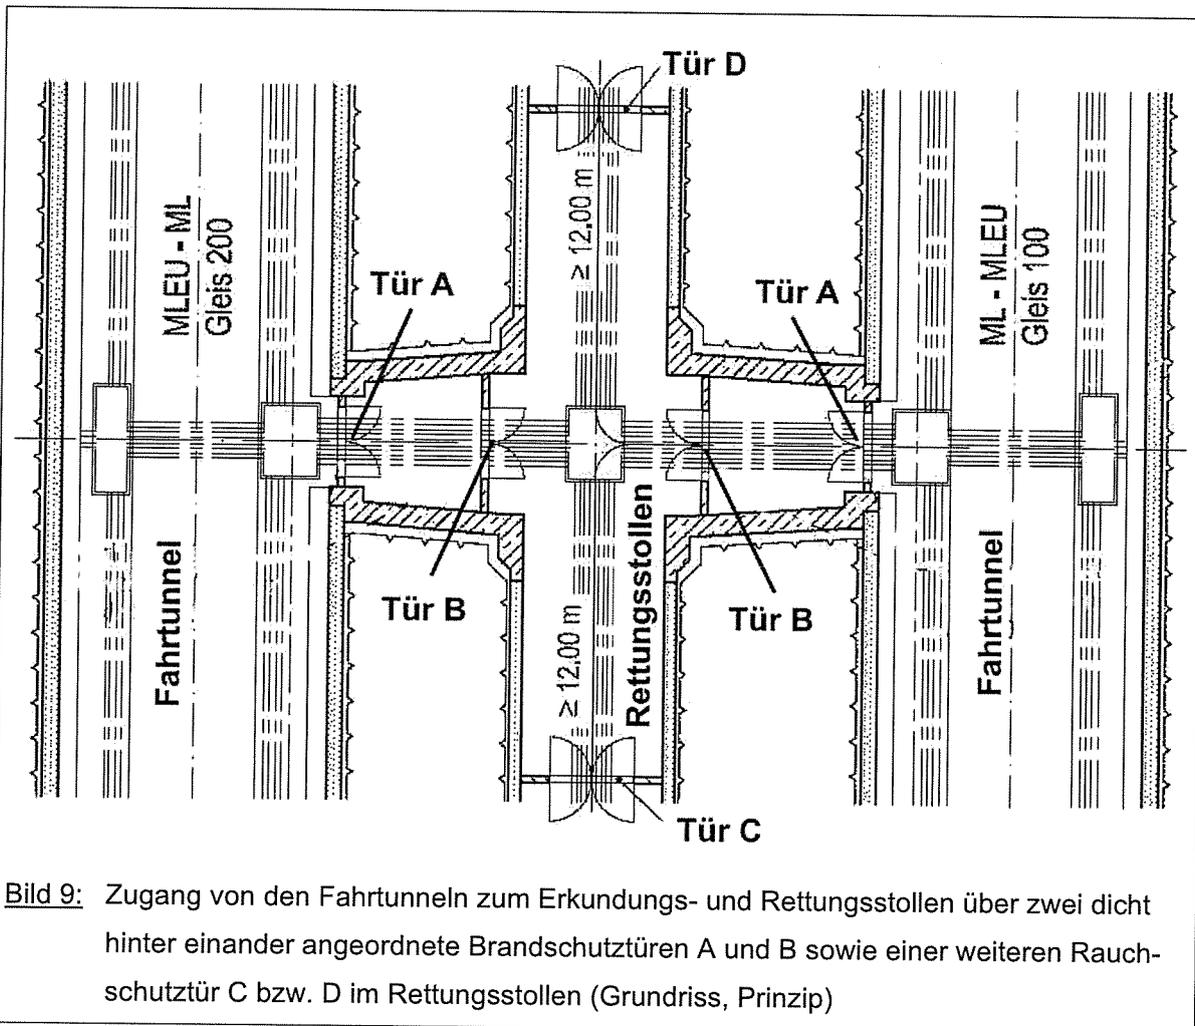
Zugang von den Fahrtunneln zum Erkundungs- und Rettungsstollen über zwei dicht hinter einander angeordnete Brandschutztüren A und B sowie einer weiteren Rauchschutztür C bzw. D im Rettungsstollen (Grundriss, Prinzip)
